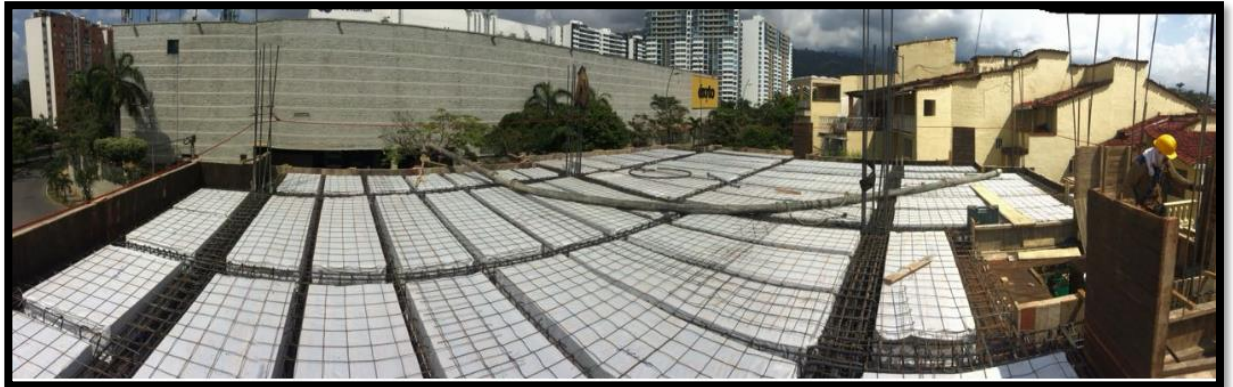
Armado vigas principales y secundarias placa segundo piso
